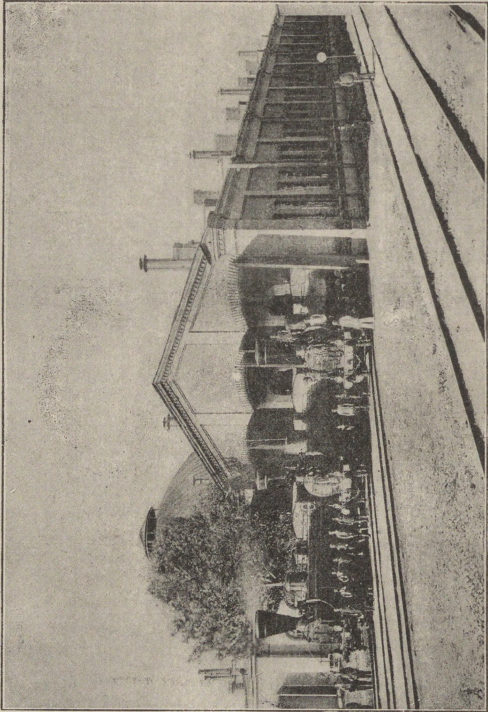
Прямоугольное паровозное зданіе на ст. Тверь.
